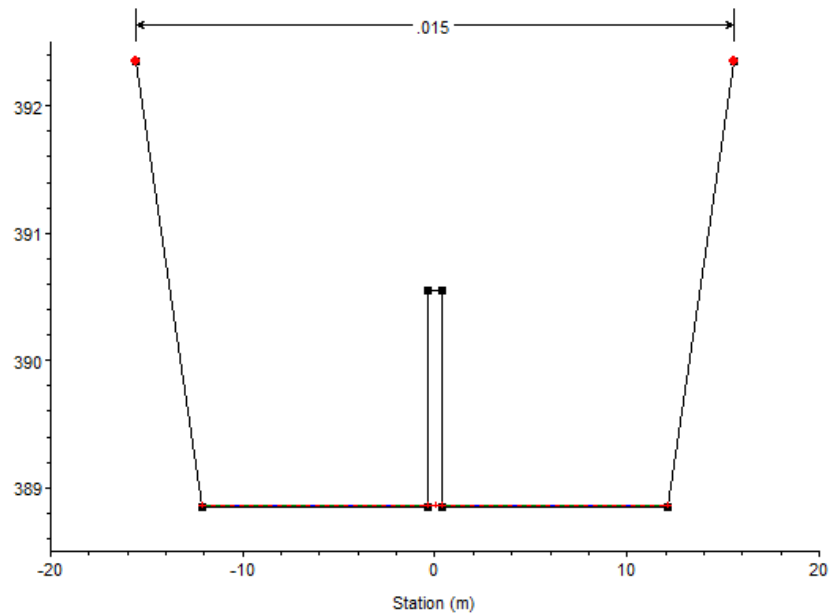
Sección tipo 1, tramo 1.2 del canal de Monegros.
